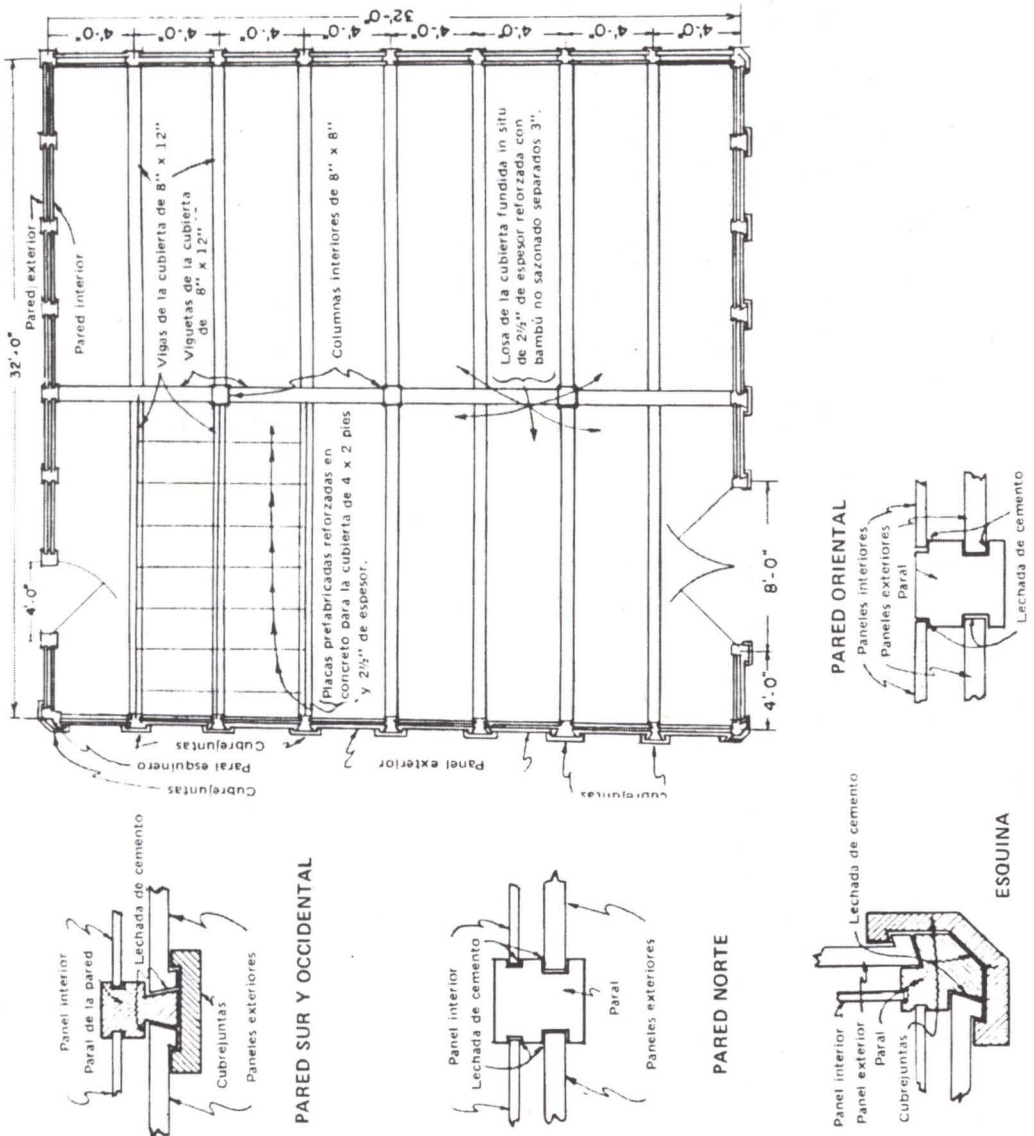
Planta del primer piso del edificio de carpintería, prefabricado de concreto reforzado con bambú (concreto reforzado con bambú, Clemson Agricultural College)
